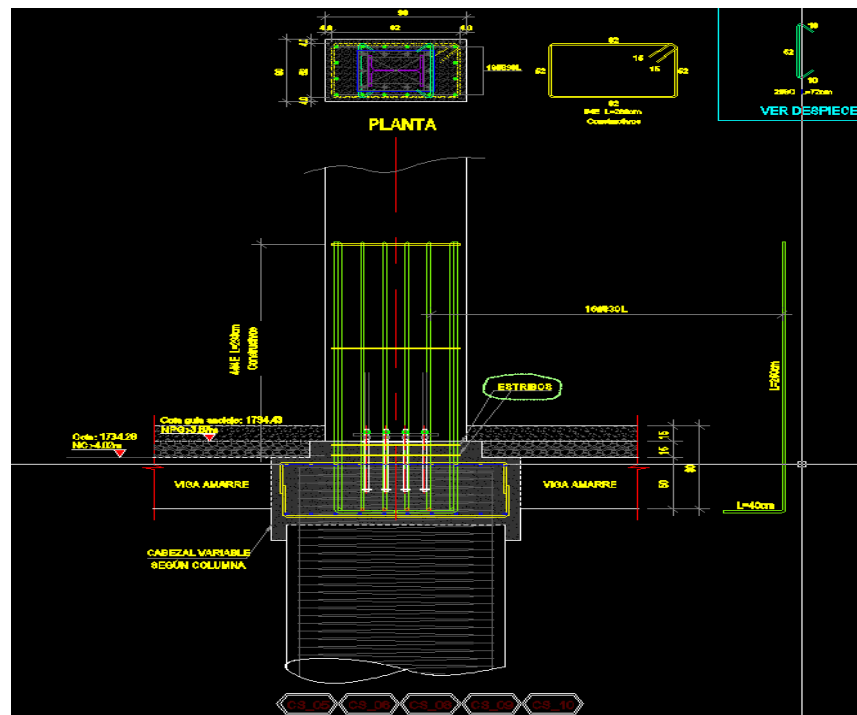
Conexión de Columna metálica con pedestal empotrado en zapata.
